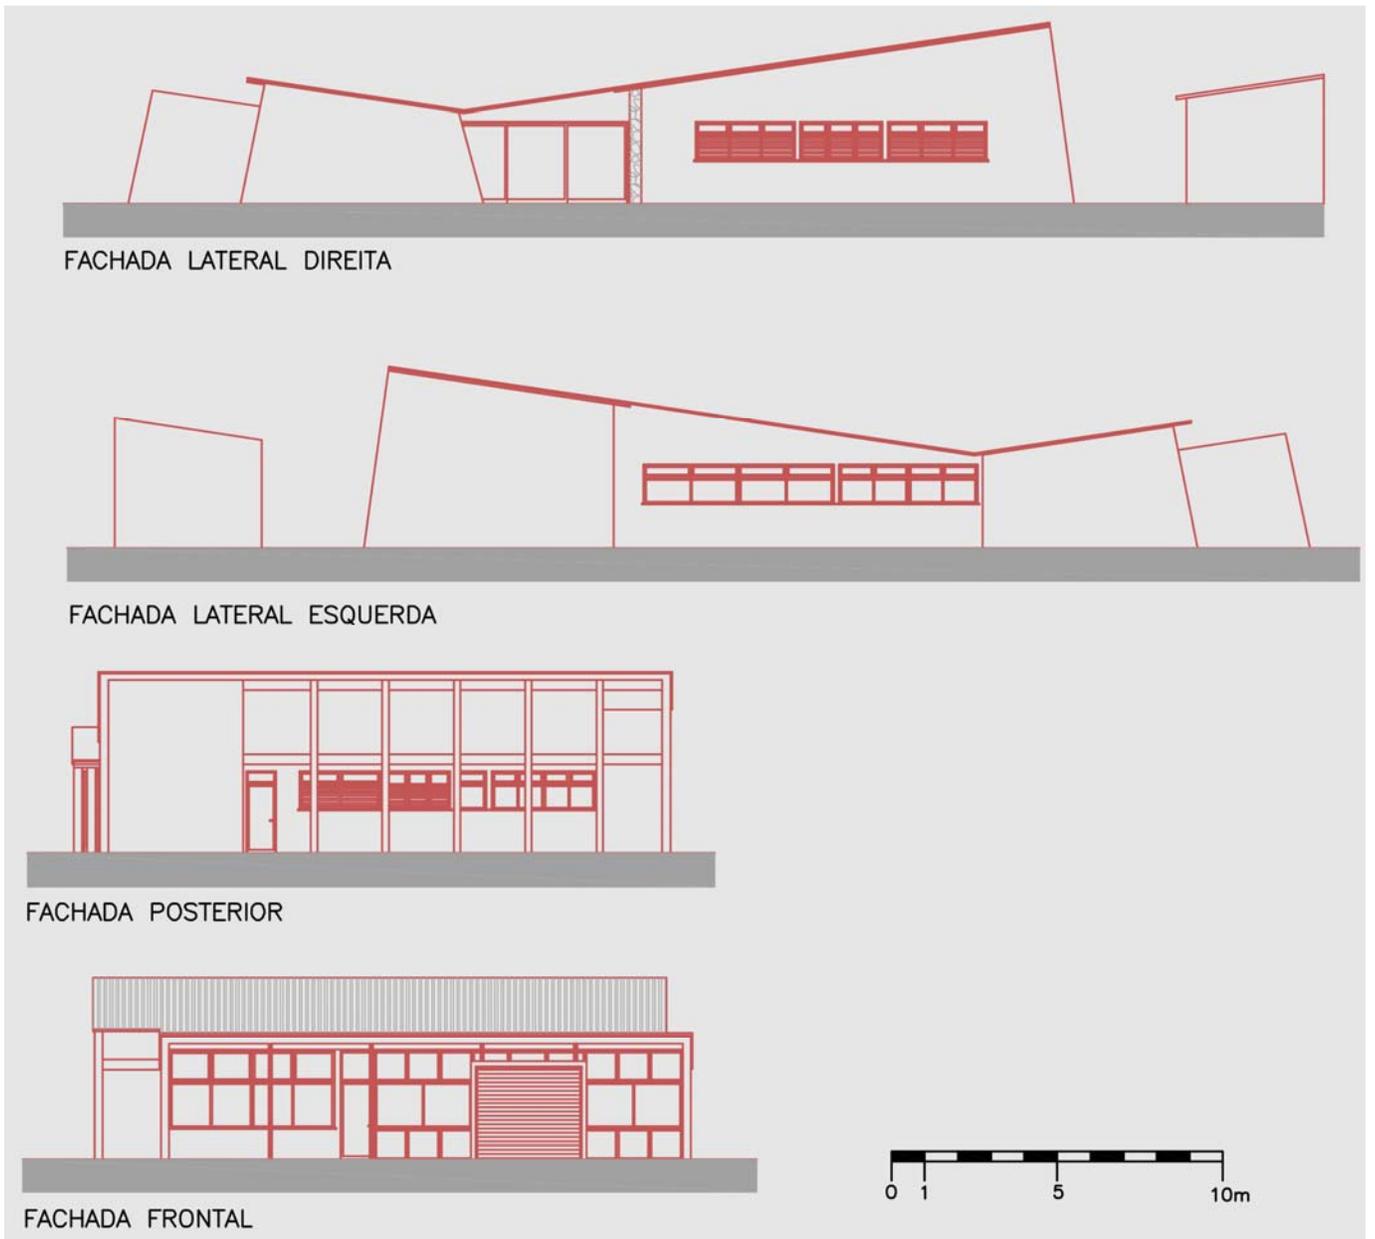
Casa Manoel Affonso Ferreira Filho, 1948 – fachadas
